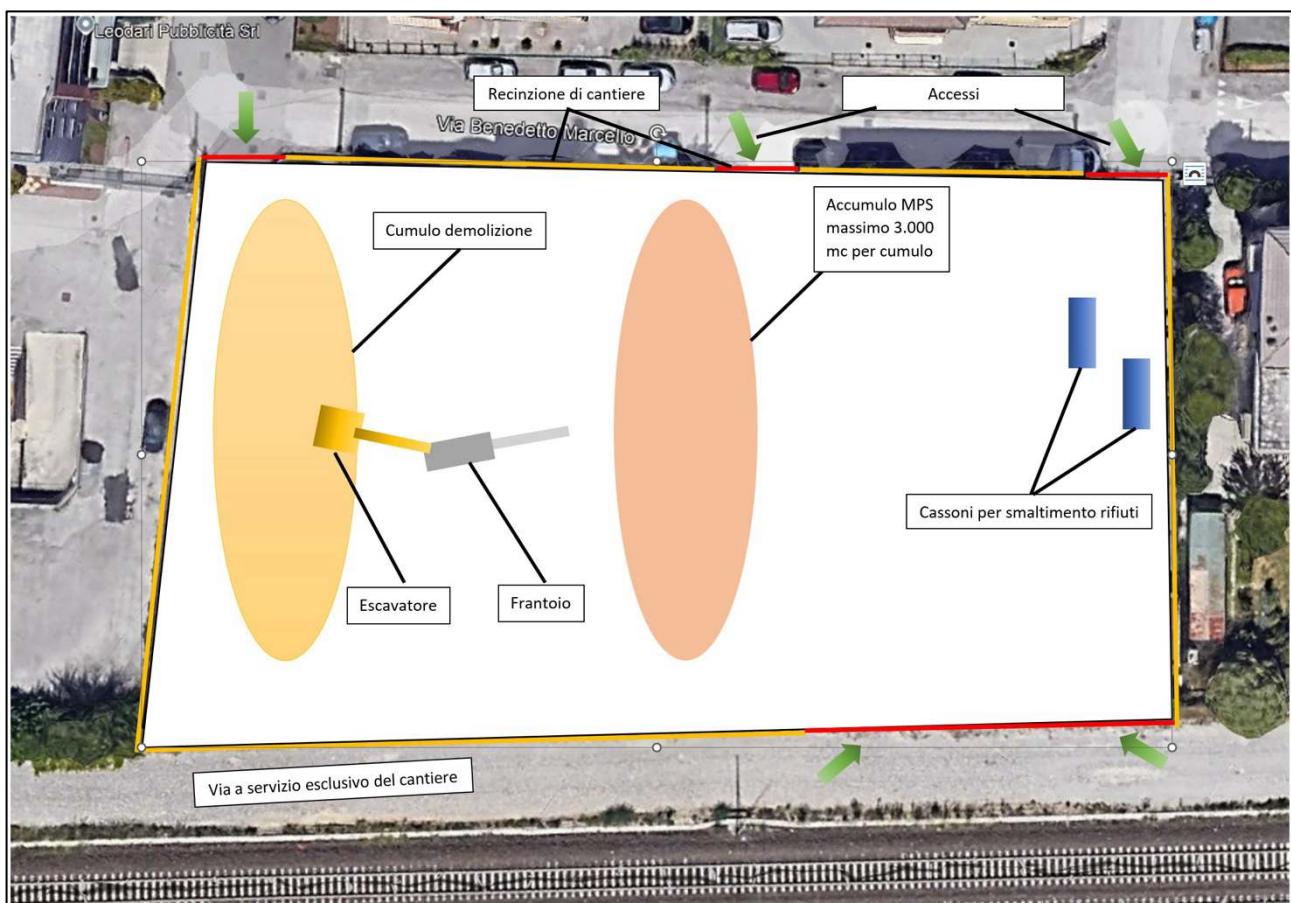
Planimetria delle aree di lavoro e stoccaggio in via Boccherini (altezza civico 20)
